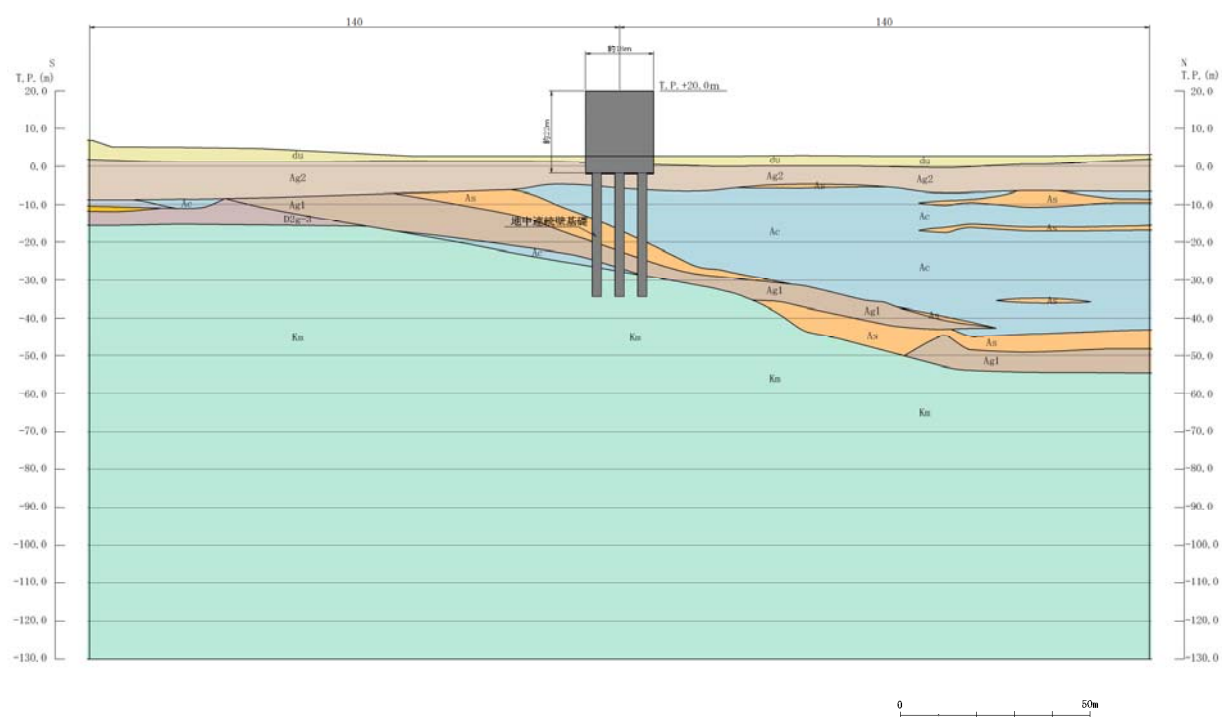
(3) 鉄筋コンクリート防潮壁 評価対象断面図 (③-③断面)
